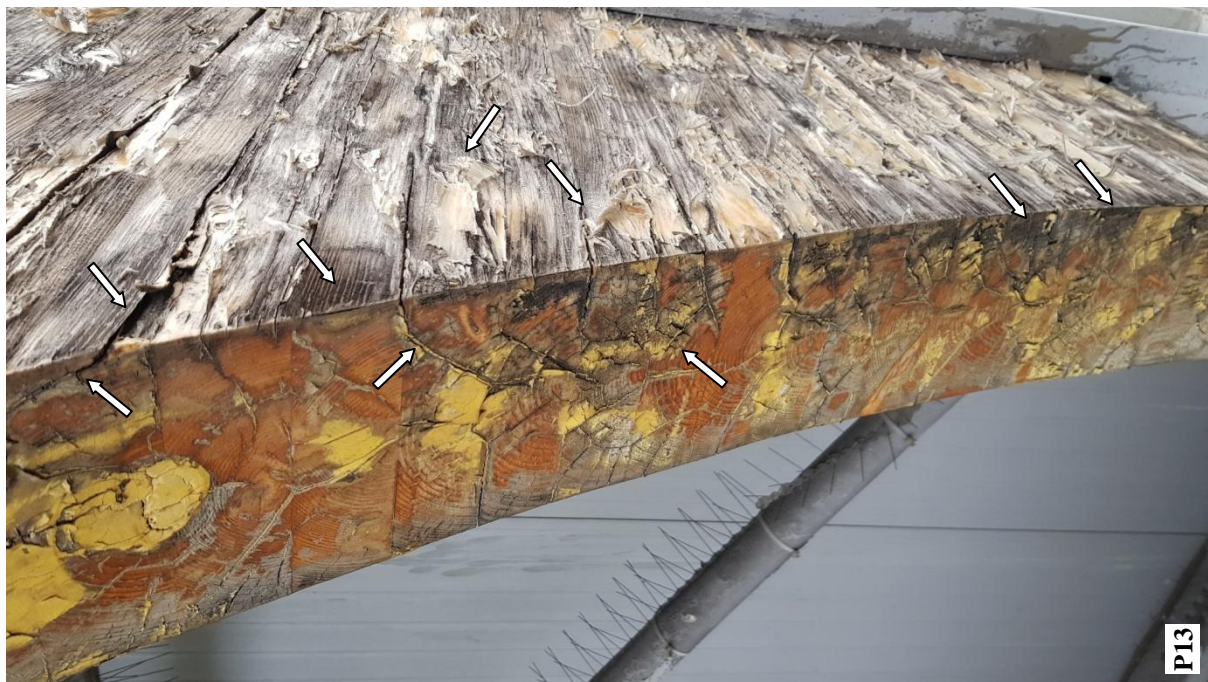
Stan zewnętrznych części dźwigarów od strony zachodniej
